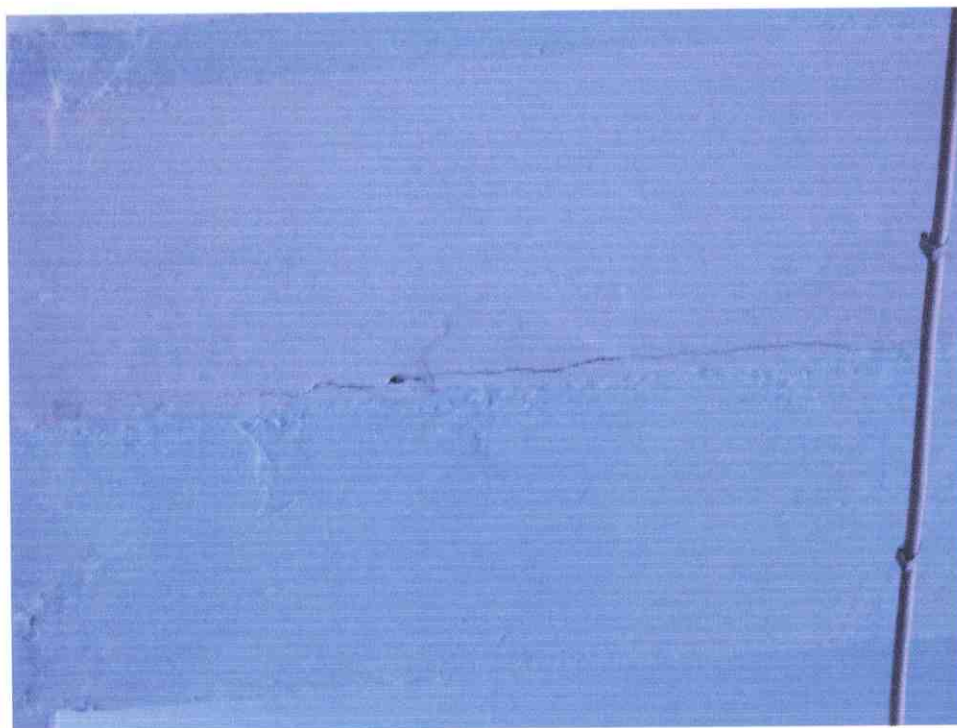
Spękania otuliny dolnego zbrojenia ram żelbetowych
